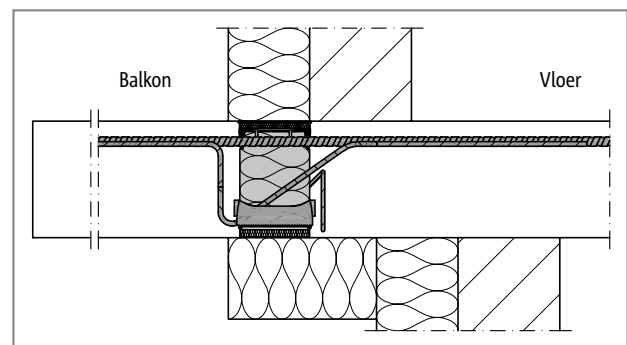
Schöck Isokorb® CXT type K-E: aansluiting bij spouwmuur
